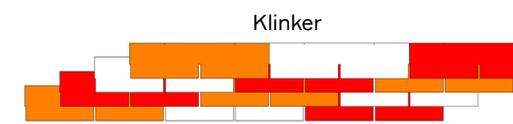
(б) – Схема чередования фасадной плитки Klinker. Каждый цвет соответствует отдельной упаковке фасадной плитки.
